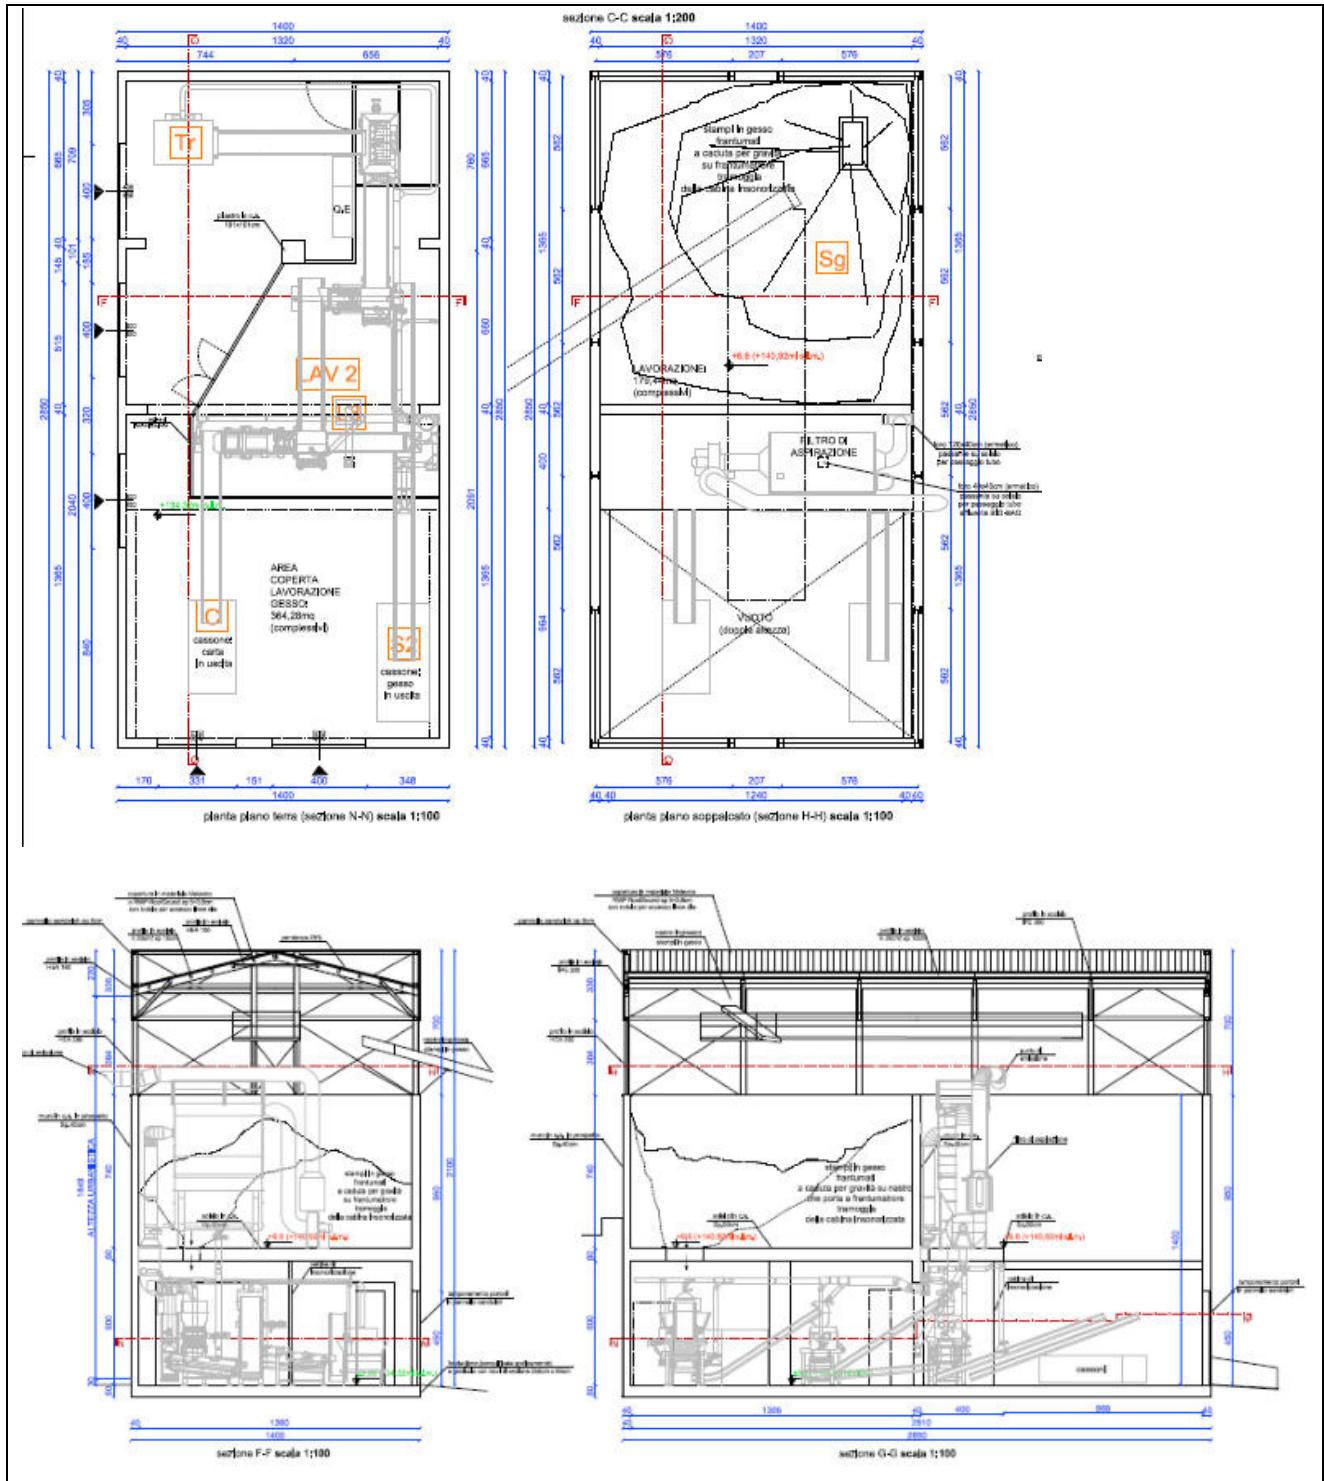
estratto S9 003_19 PAUR_Tav 04 R2_st prog plan A dett pianta prosp sez_pe_2023.04.01
